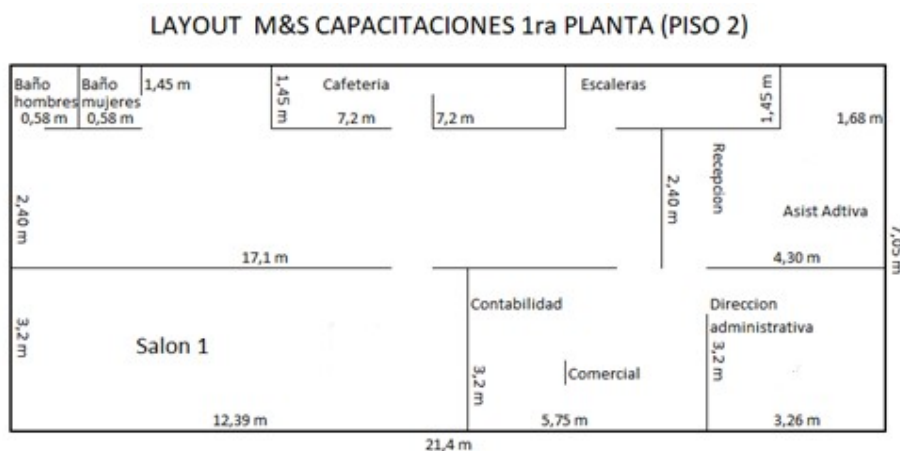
Layout primera planta, segundo piso. Elaboración propia (2019)
